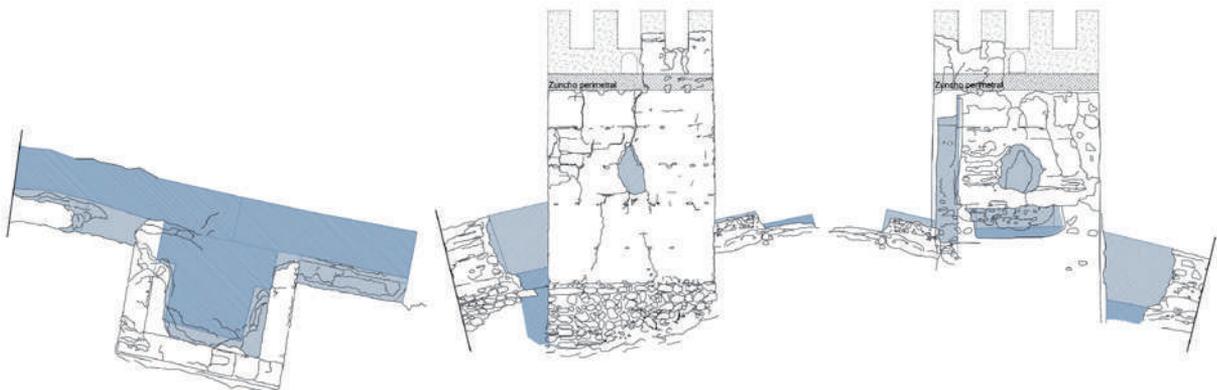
Plano planteamiento inicial. Planta, alzado sureste y alzado noroeste.
